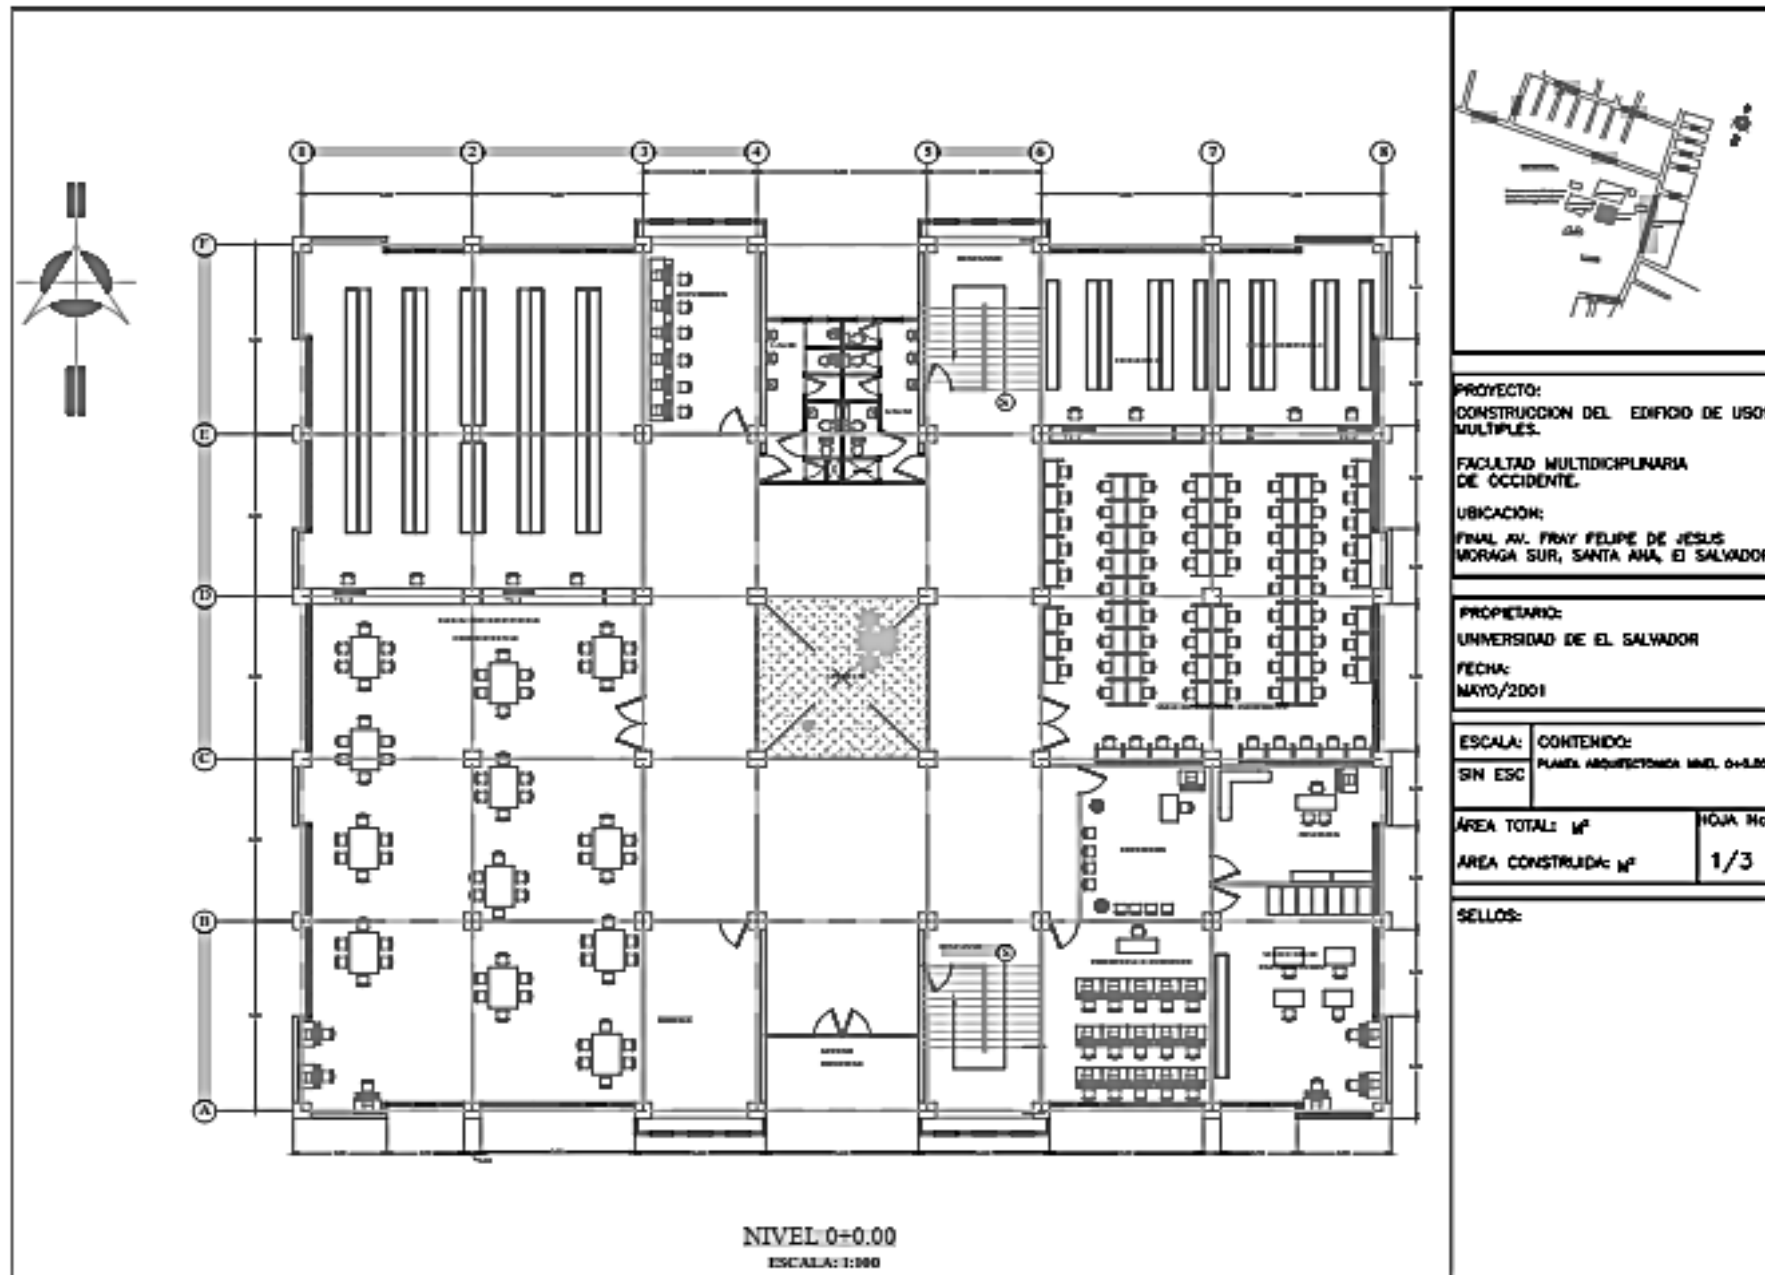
Planta Arquitectónica Nivel 0+0.00 del edificio en evaluación.
